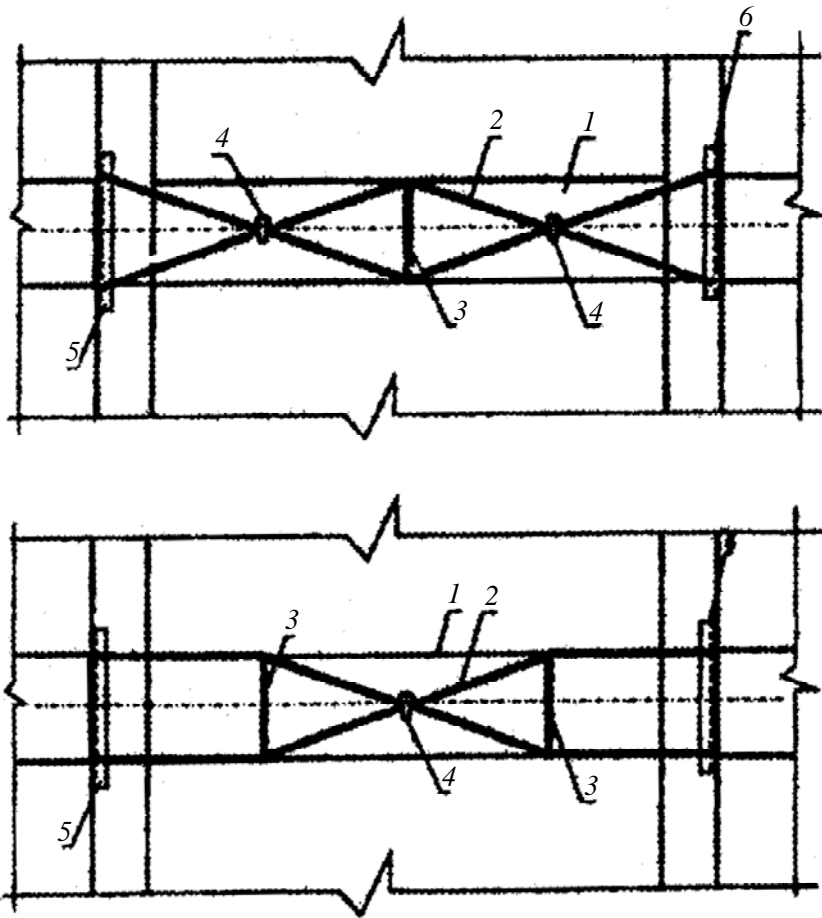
Усиление балки дополнительной предварительно напряженной арматурой с промежуточными распорками:
